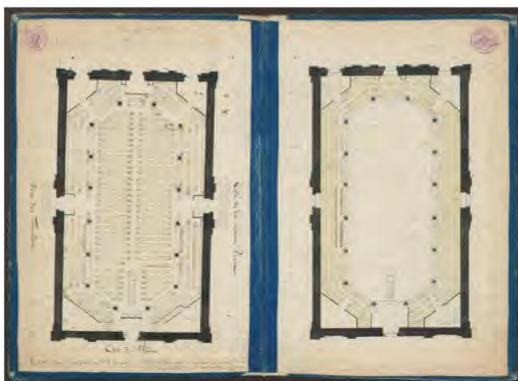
1813. Plan du temple de la Fusterie. Places numérotées et louées plan. Bg27.1
